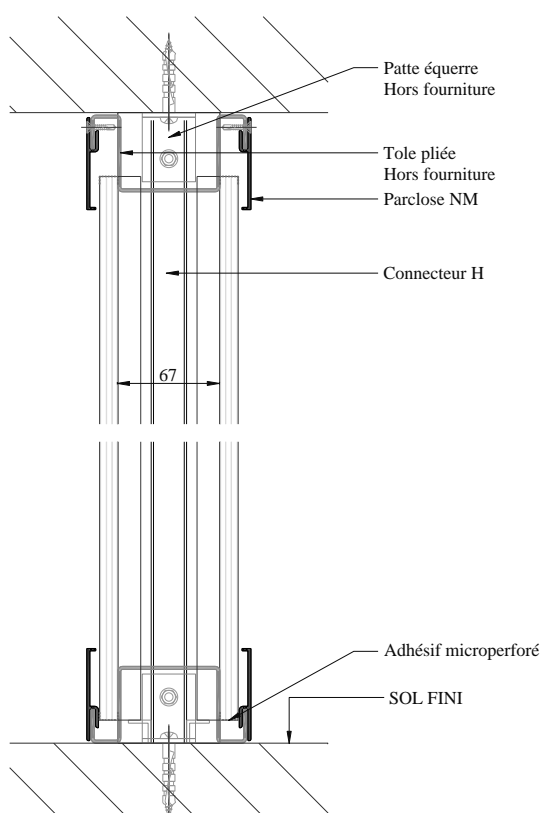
Coupe verticale – système DANPALON® application cloison double paroi
